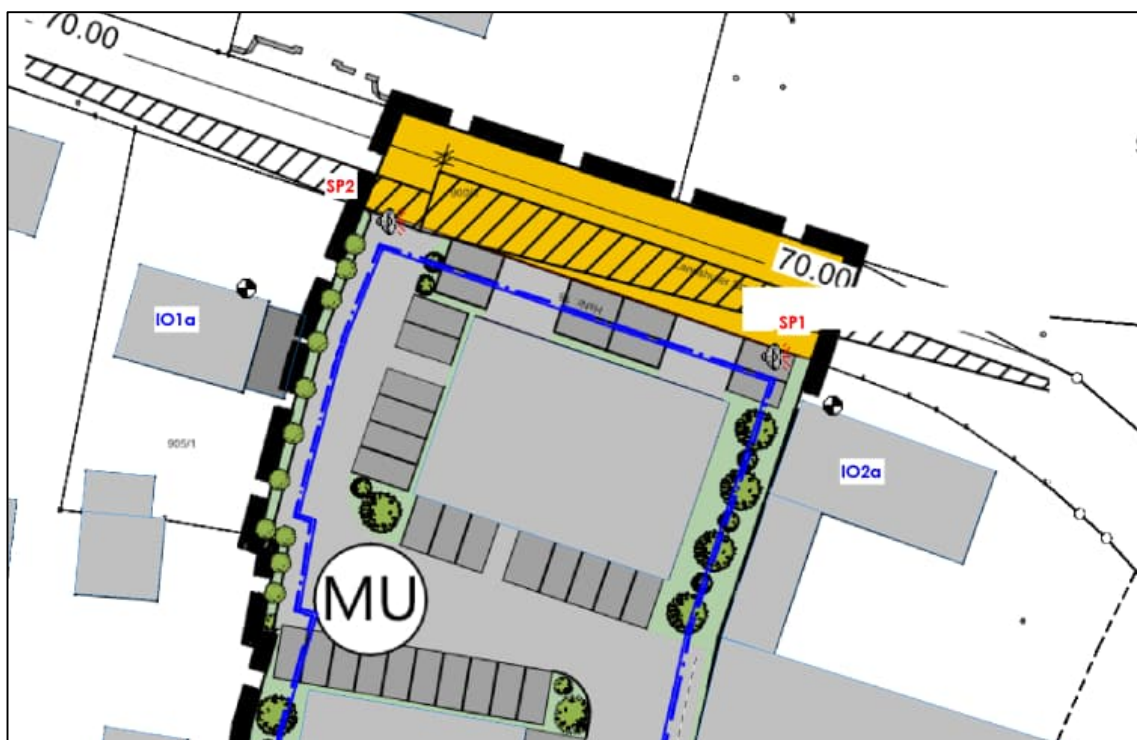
Lageplan mit Darstellung der Punktschallquellen (SP) sowie der Immissionsorte (IO)
